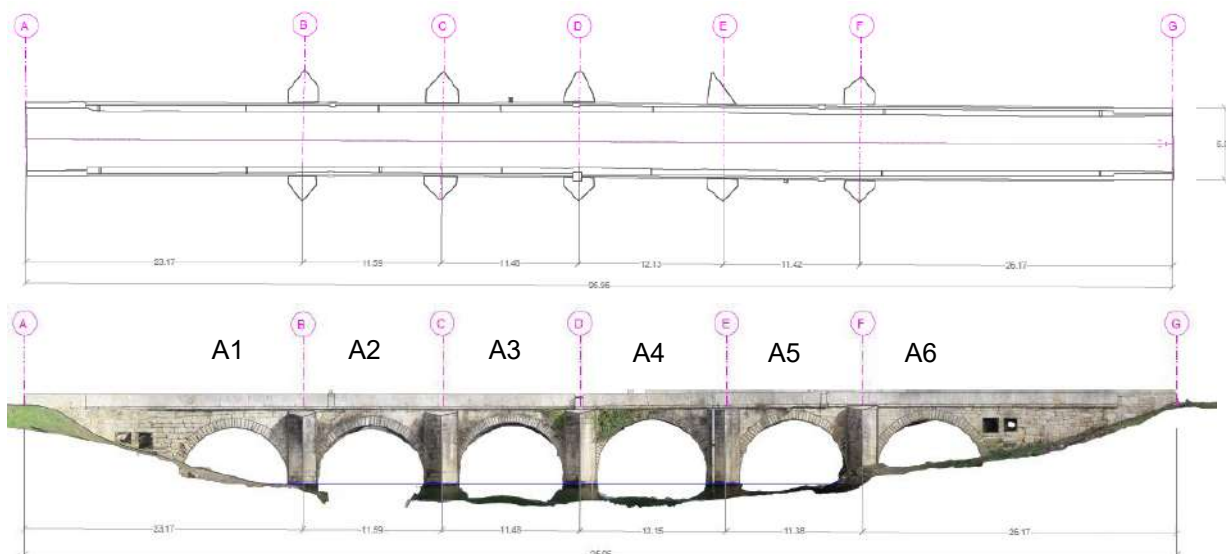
Planta e Ortofotografia do alçado Sul
